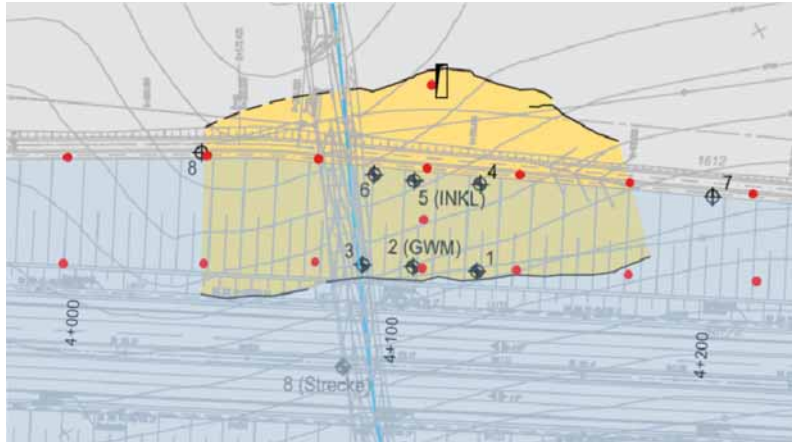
Lageplan des Schadensbereichs mit Aufschlusspunkten und Messmarken.
